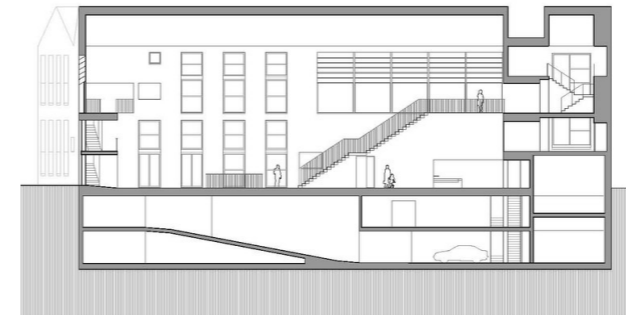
Sección Longitudinal Fuente: Duccio Malagamba, 2013.
